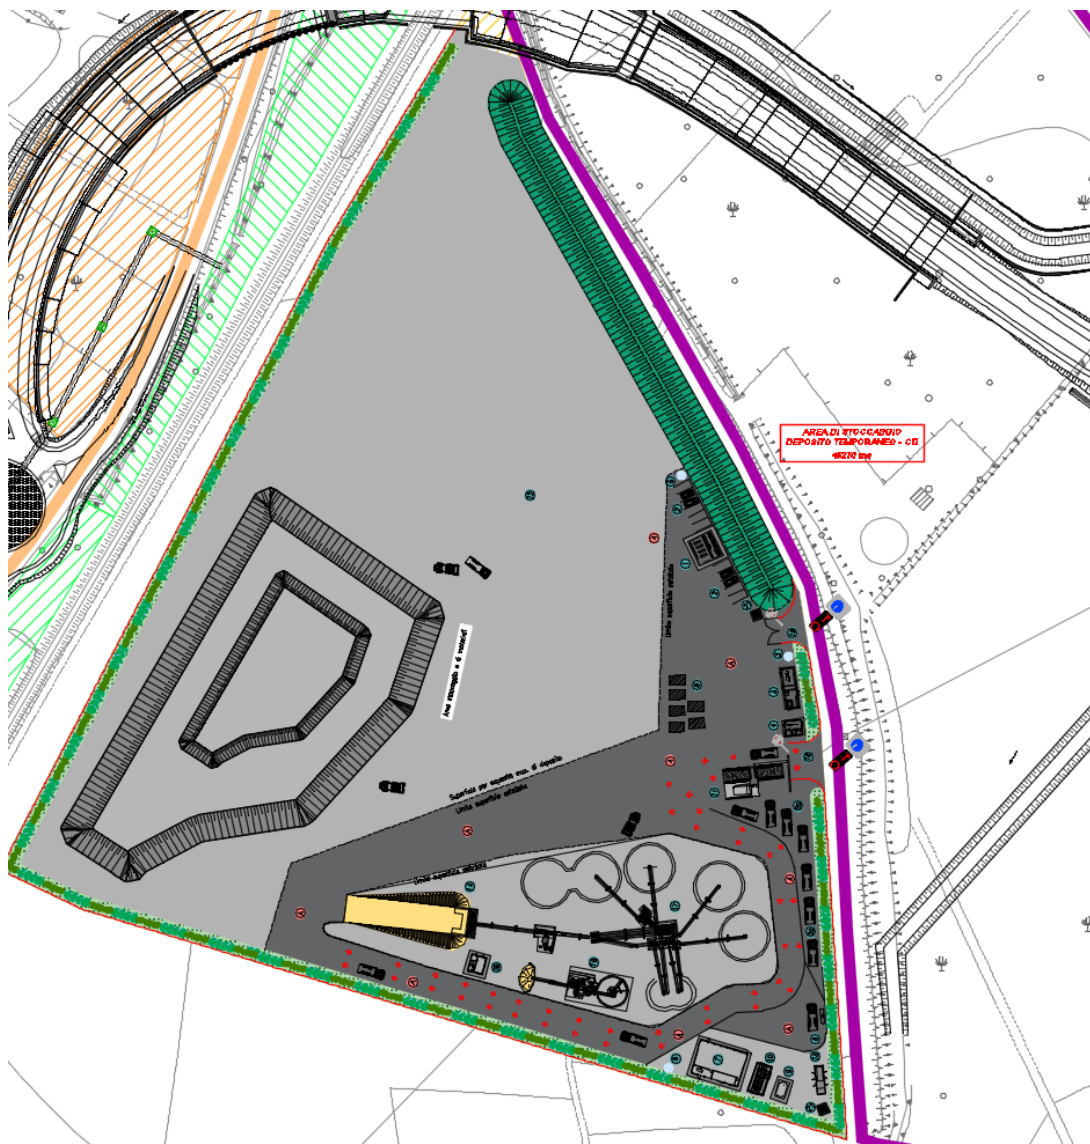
AREA CANTIERE DI STOCCAGGIO
